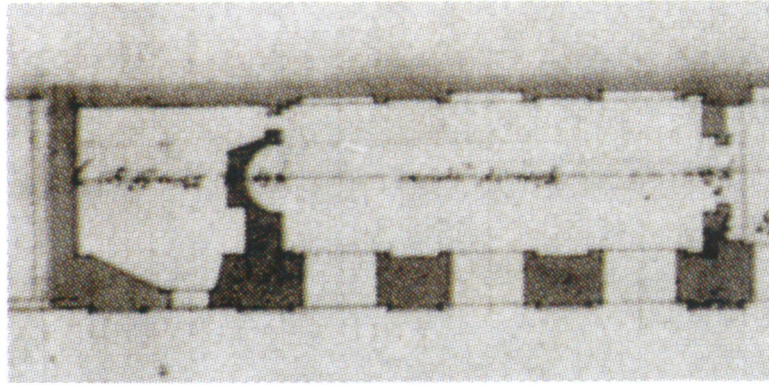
Anonym, Grundriss des Château-Neuf von Saint-Germain-en-Laye, vor 1777, Detail der Neptun-Grotte.
